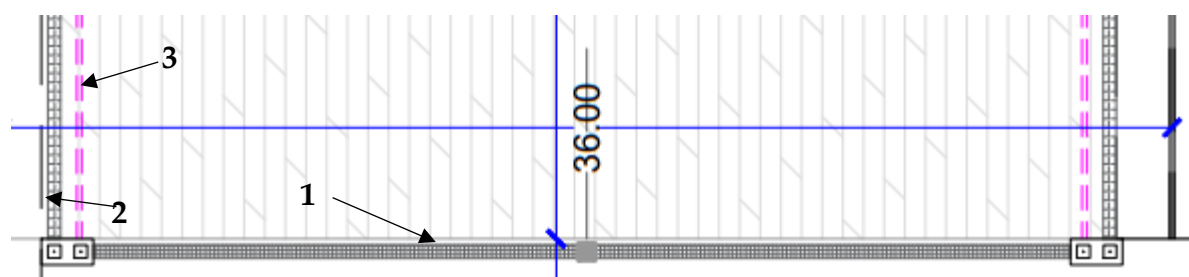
Dettaglio delle canalette e delle tubazioni di drenaggio della platea insilati (n. 22)
